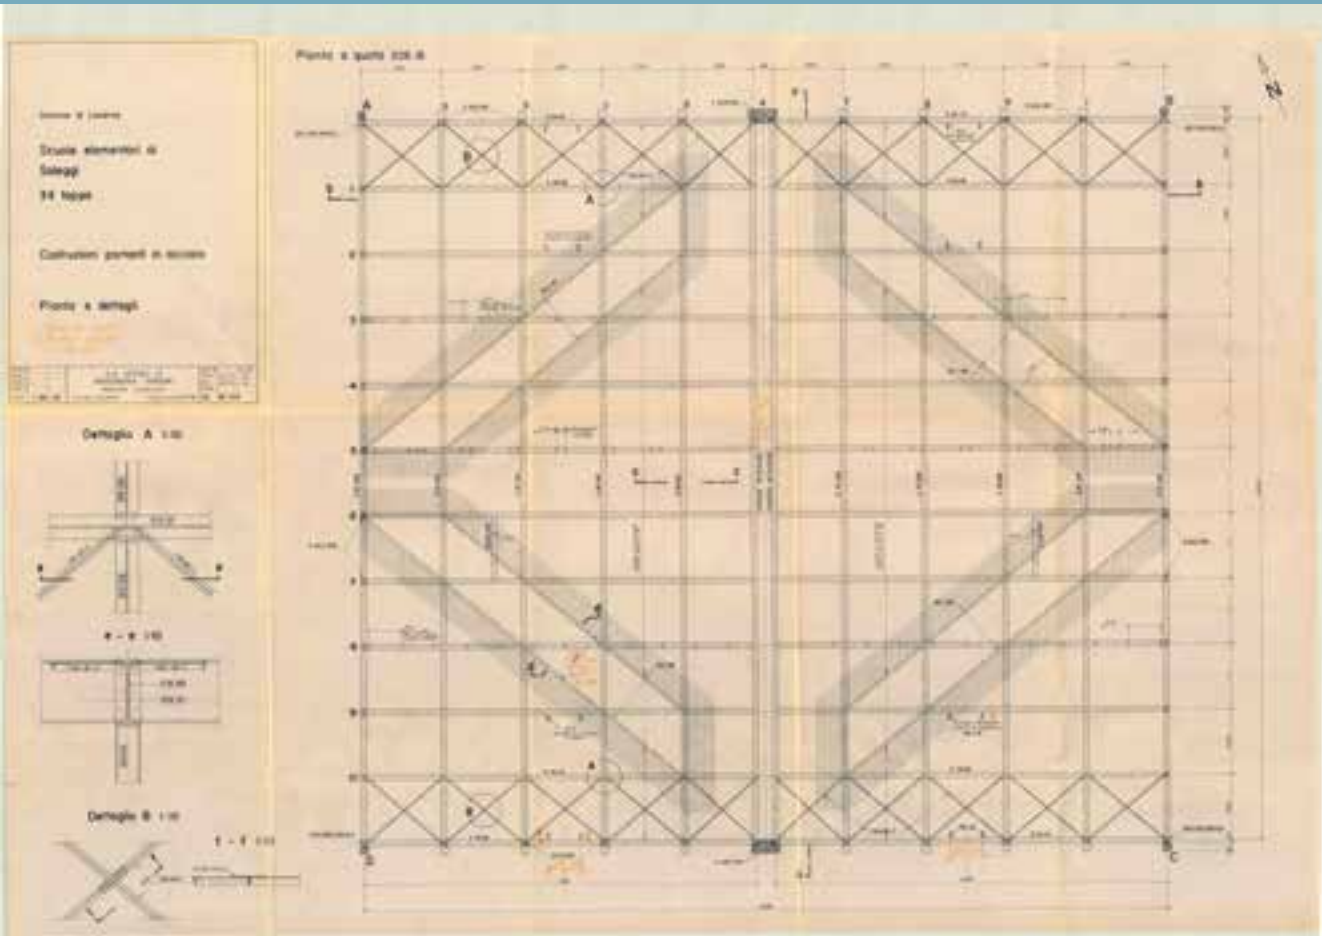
Figura VIII. Ufficio di Ingegneria Maggia, Struttura metallica della palestra, pianta e dettagli, 15 febbraio 1977 (AIMME).
